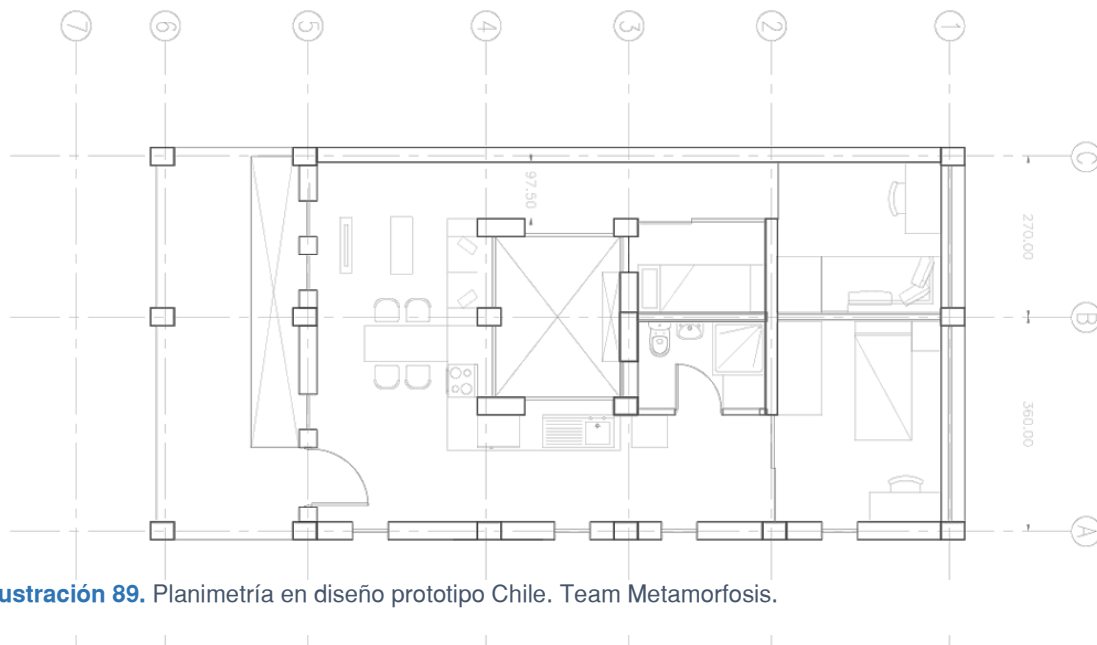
Planimetría en diseño prototipo Chile. Team Metamorfosis.
